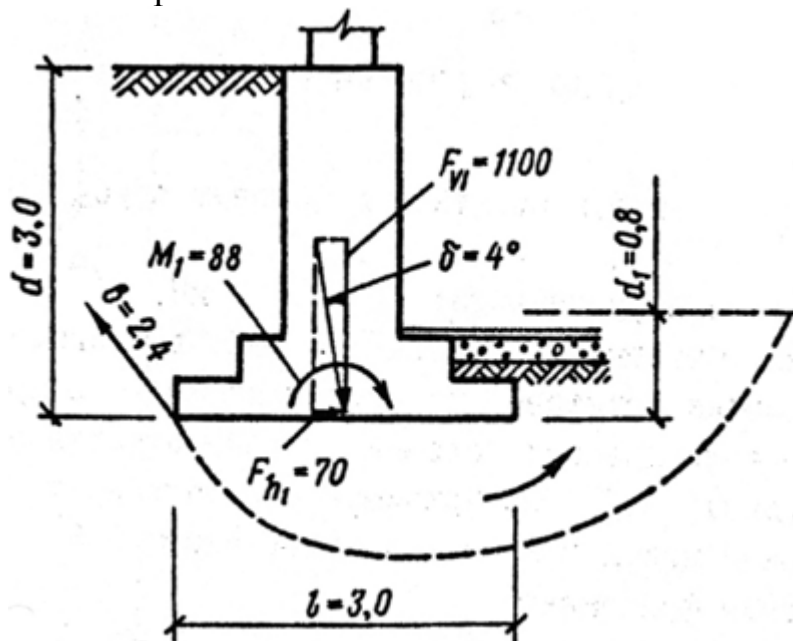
Расчётная схема к определению устойчивости отдельно стоящего фундамента под колонну (расчёт основания по несущей способности).
